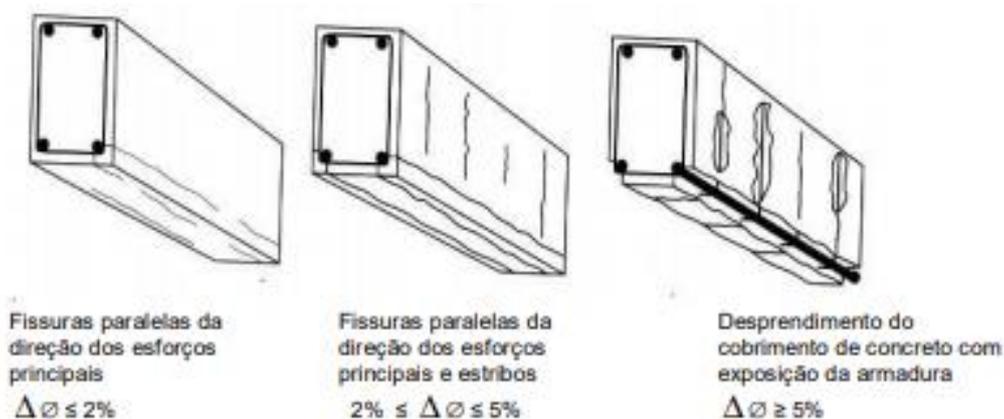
Representação esquemática das patologias comumente observadas em vigas de concreto armado afetadas por corrosão. Fonte: Helene, 2003.
